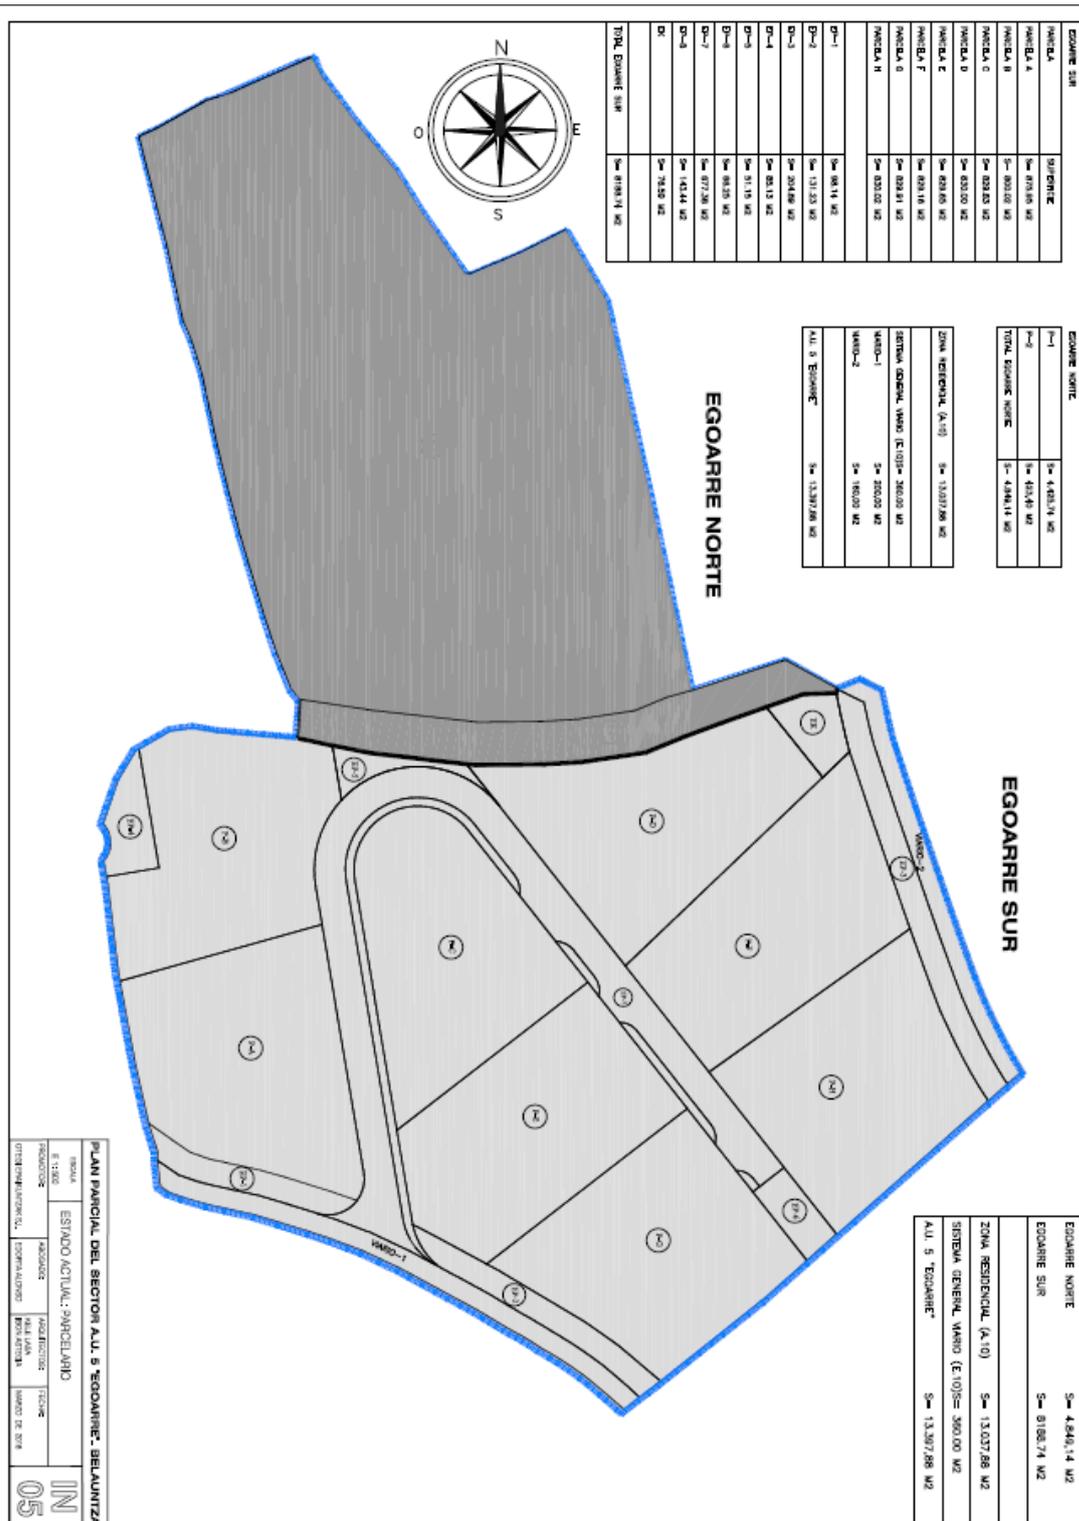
Egoarre Sur, ámbito de la U.A.5 ya consolidado.
